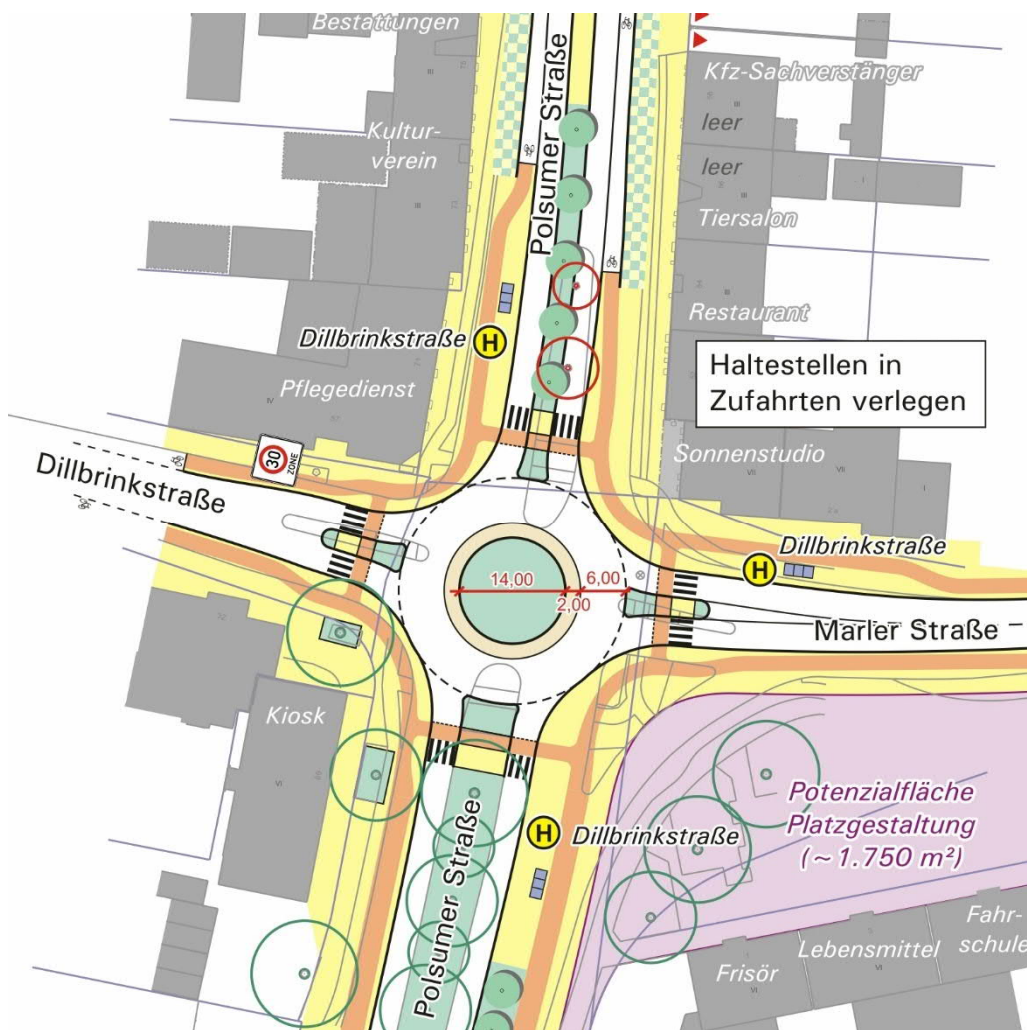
Knotenpunkt Polsumer Straße/Marler Straße/Dillbrinkstraße – kleiner Kreisverkehr (d = 30 m)
